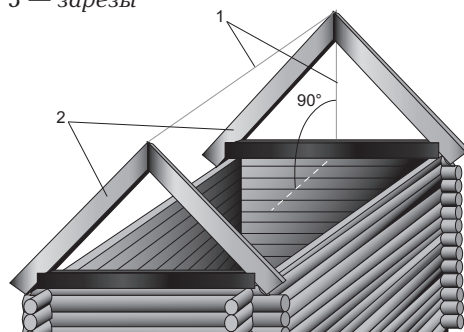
Установка крайних стропильных ферм: 1 — шнур;
